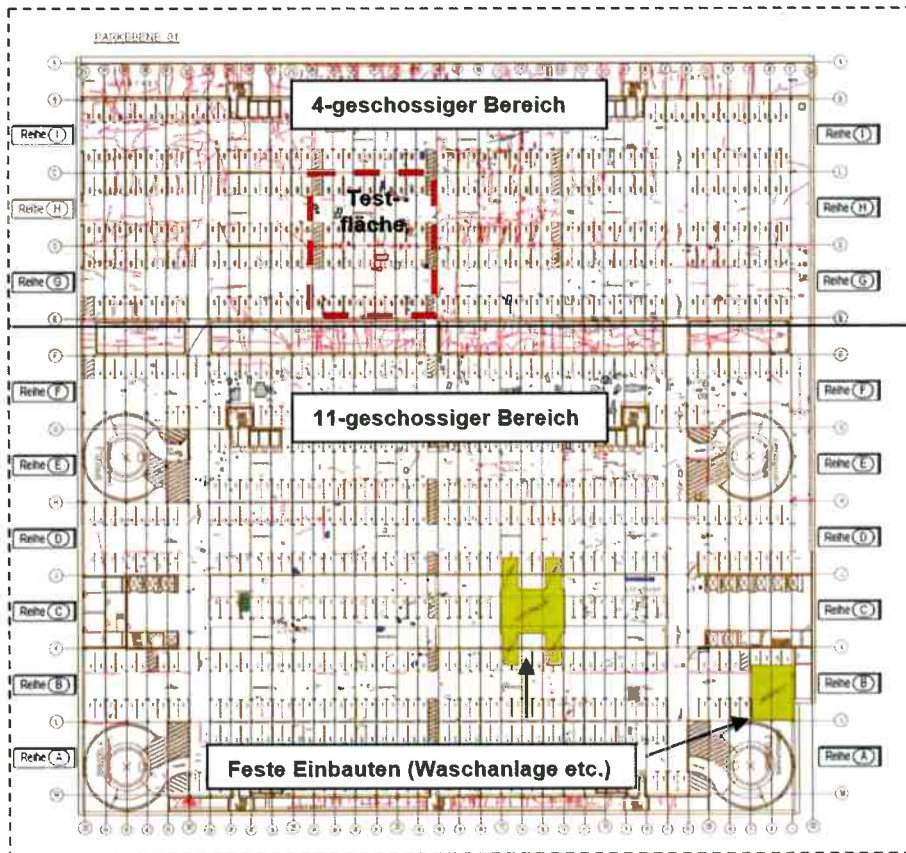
Grundriss mit Schadensdokumentation der Risse im Februar 2006
